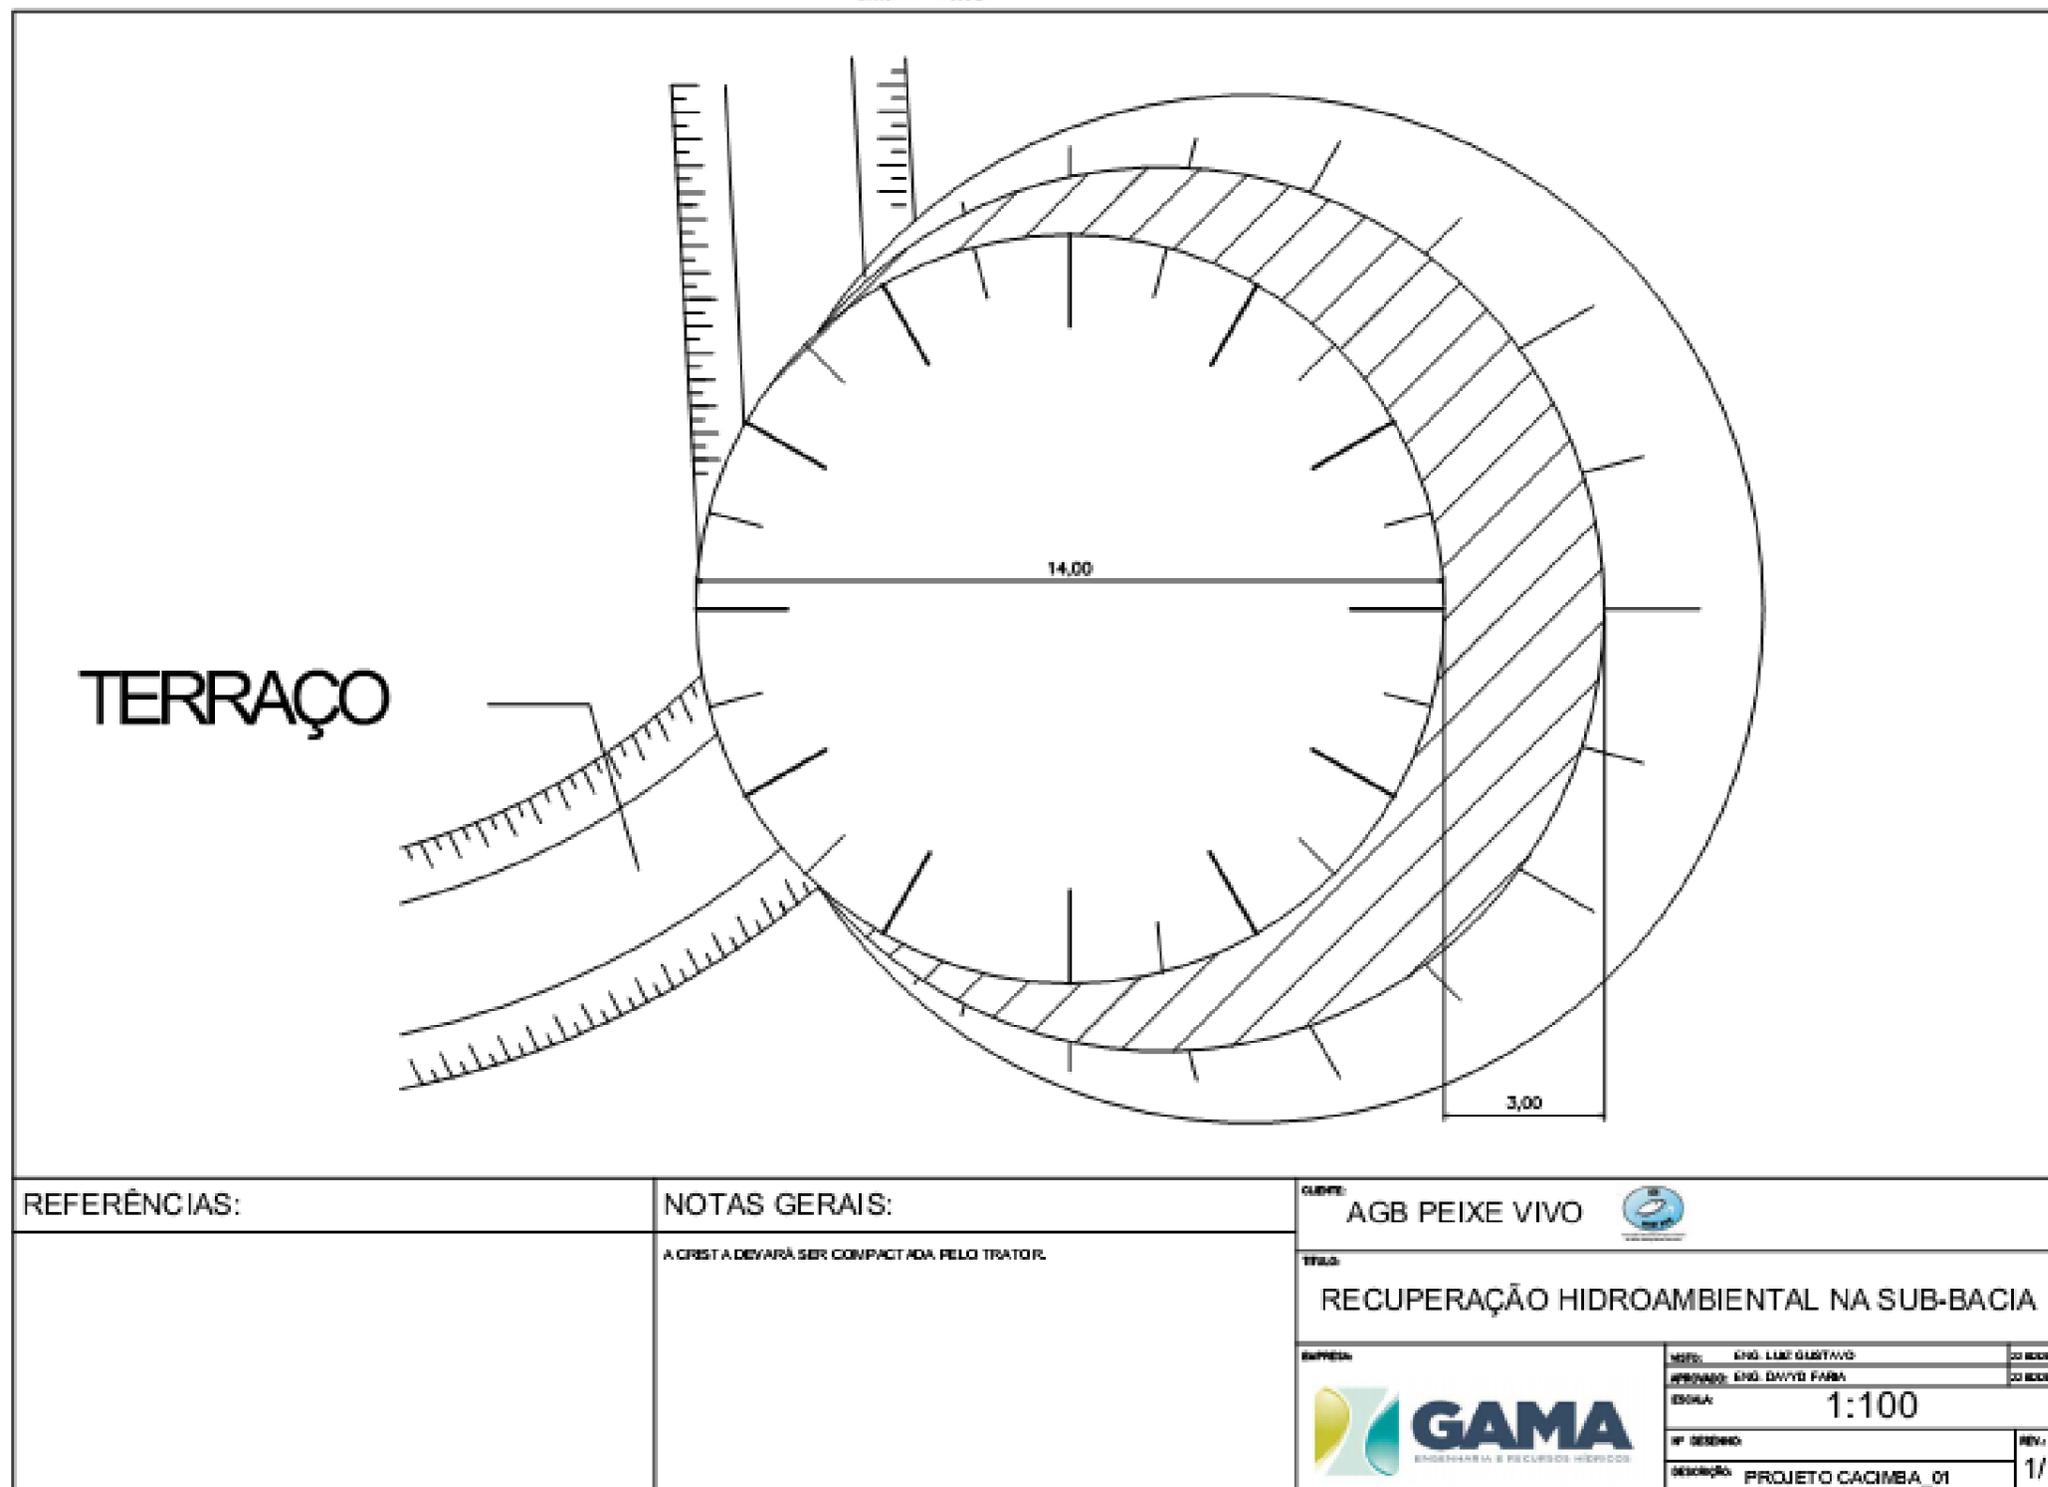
Especificações técnicas para construção dos dispositivos de
